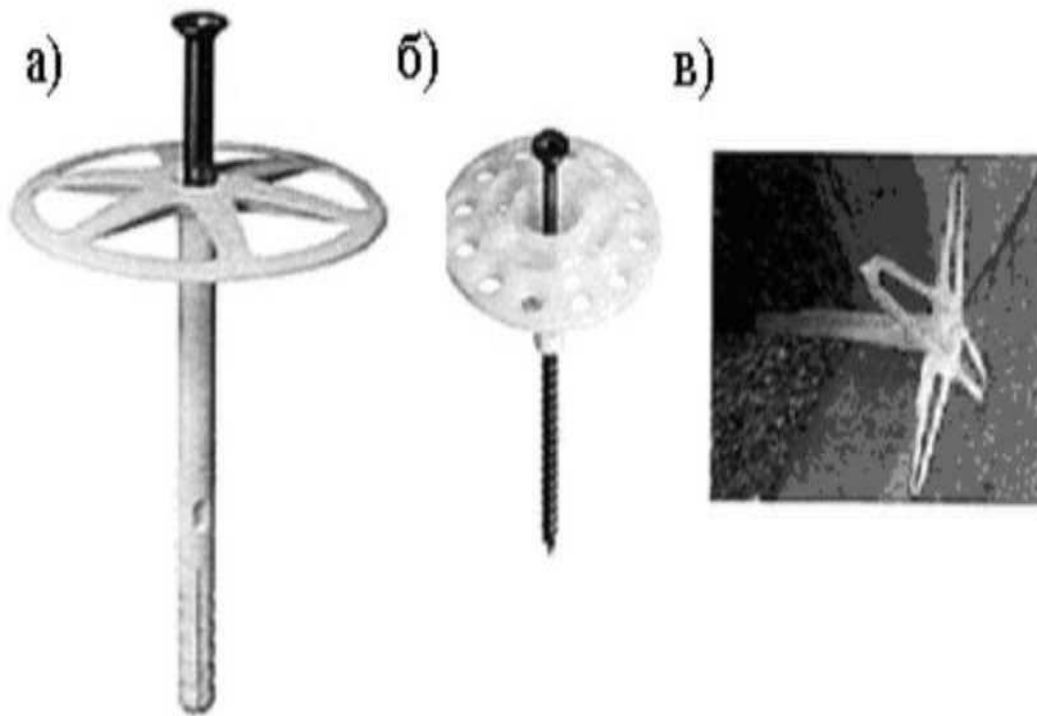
Елементи кріплення теплоізоляційних плит: а,б) - тарілчасті дюбелі фірми Koelner; в) – грибоподібний елемент фірми Hilti
